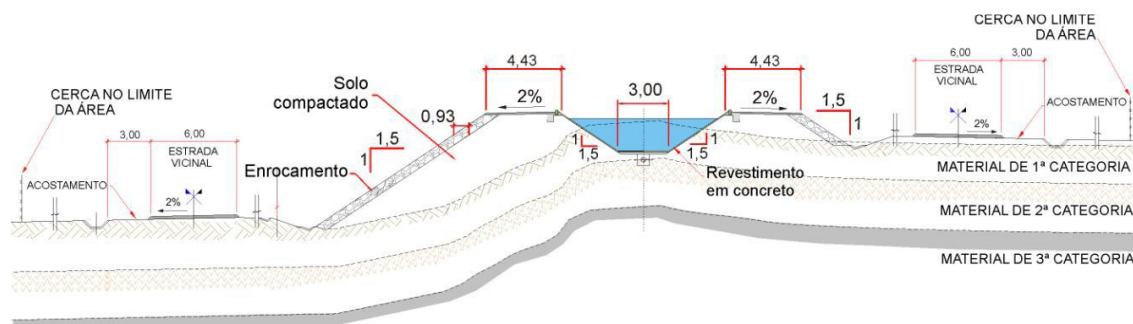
Canais em Seção Mista. Seção Transversal
